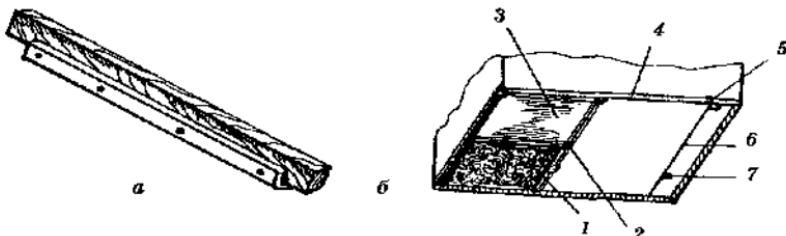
Устройство песчано-цементной стяжки: а — установка маяков; б — установка направляющих реек: 1 — деревянная рейка; 2 — маяк; 3 — заглаженная заподлицо поверхность; 4 — уровень пола; 5 — штырь для шнуря; 6 — шнур; 7 — маяки
